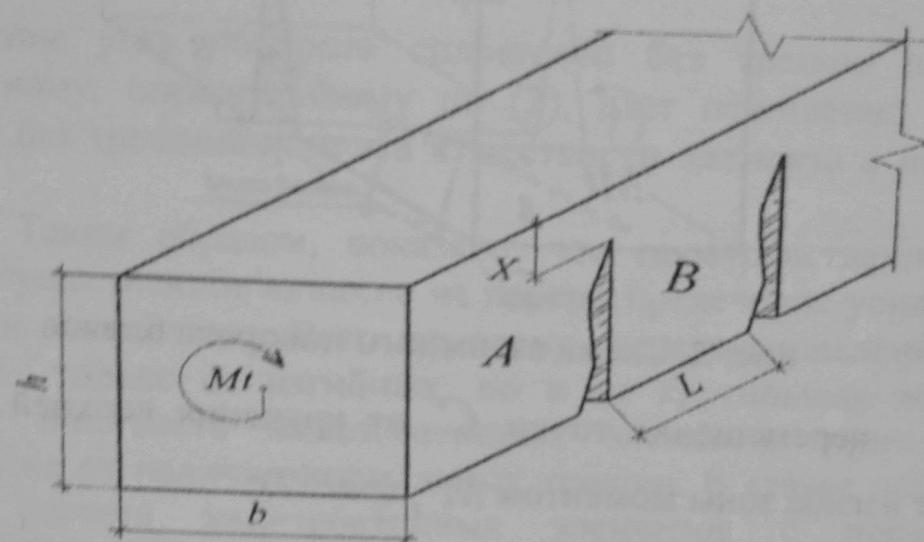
Схема железобетонного элемента с нормальными трещинами, нагруженного крутящим моментом.
